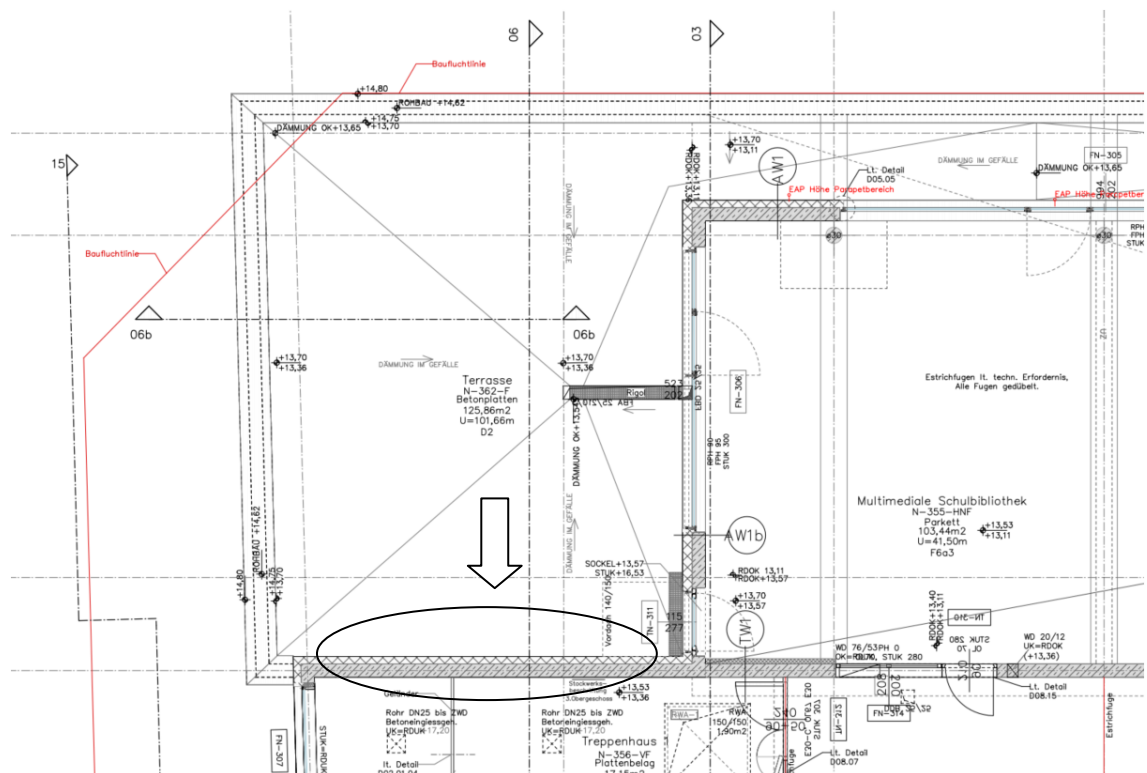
Diefenbachgasse – Position der Fassadenbegrünung im Grundriss
